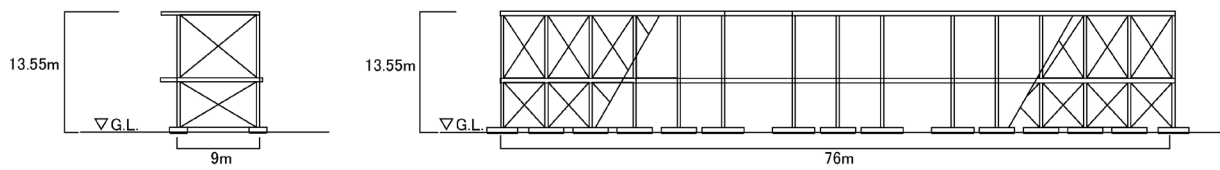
(4) 断面図 (E 設備架台、G 設備架台)
